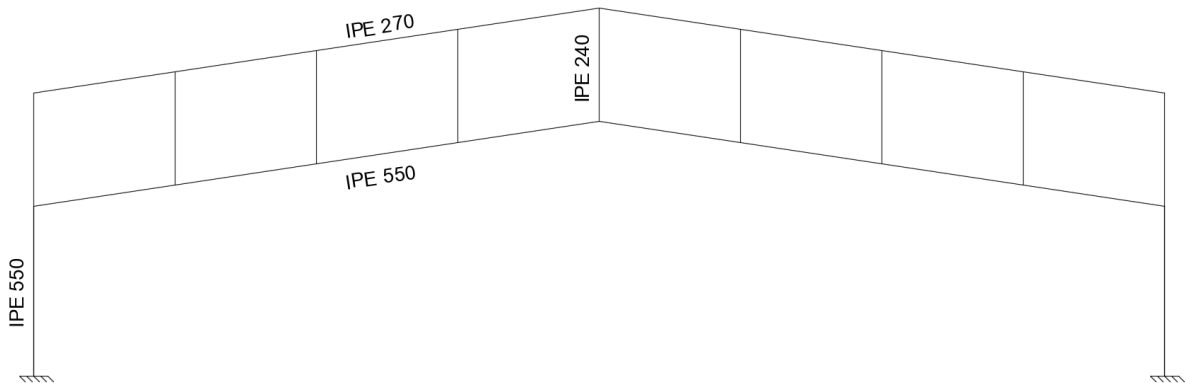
Pórtico de unión entre la zona alta y la baja
